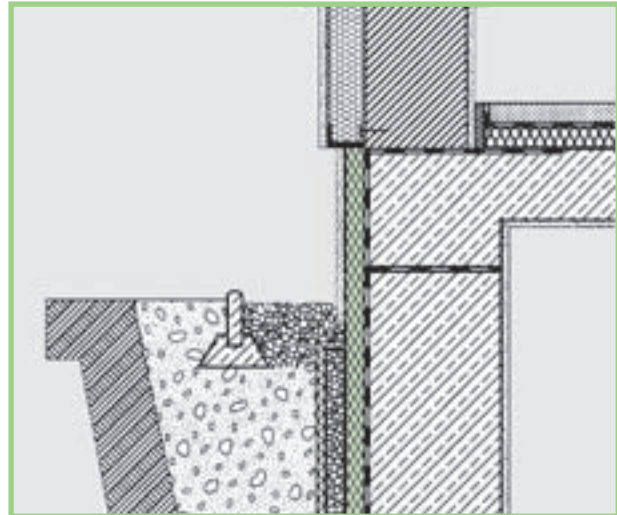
Zócalos, aislamiento perimetral con un sistema exterior de uniones de aislamientos térmicos.
